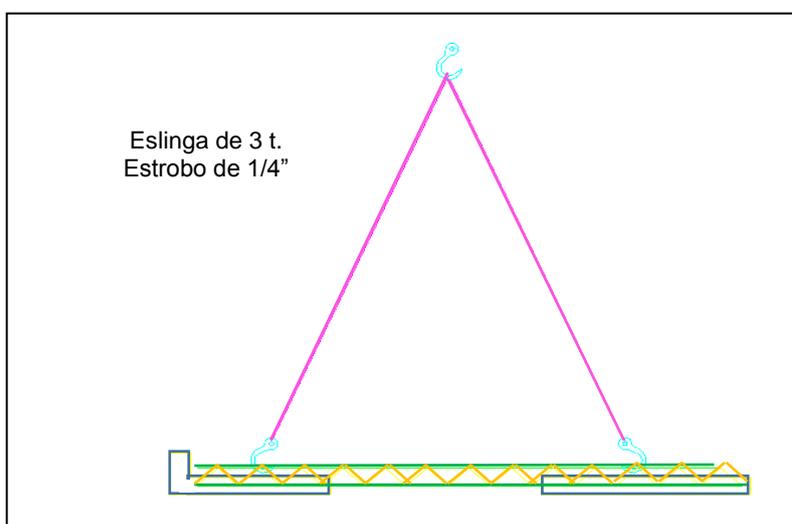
Detalle para el Izaje de Pre-losa con tralicho.
